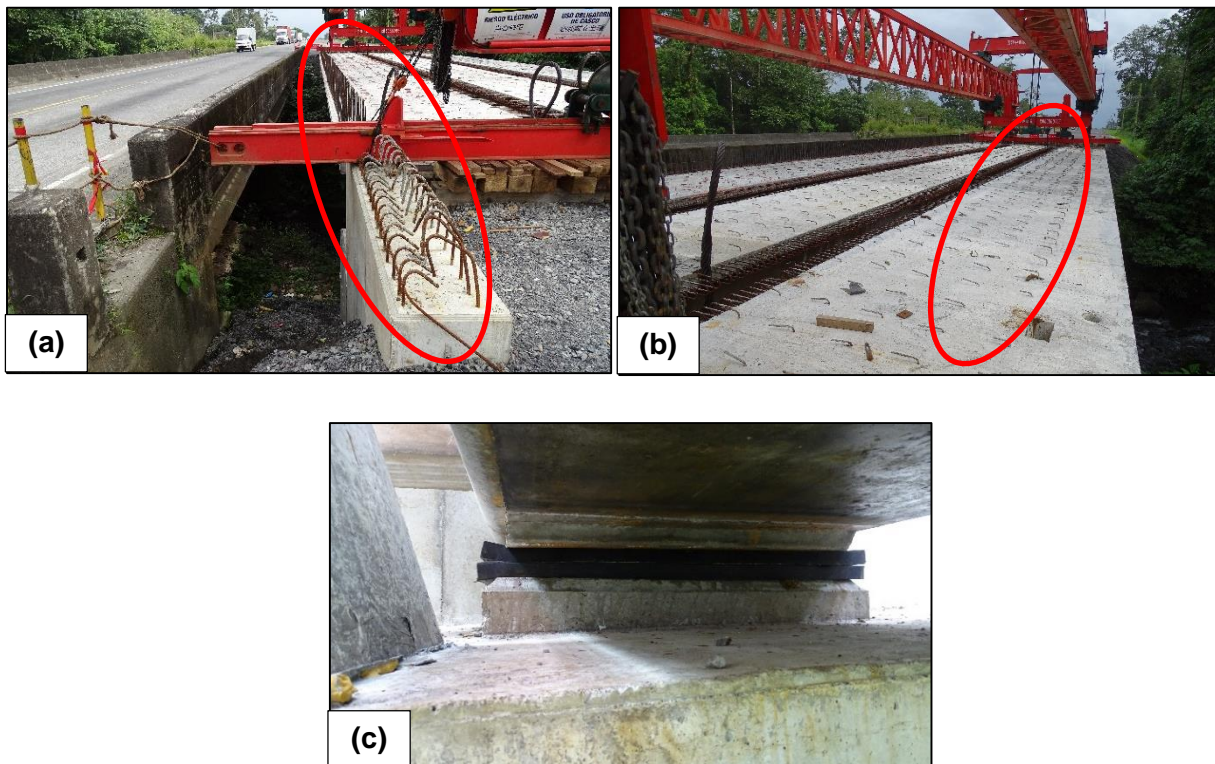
Avance en la construcción del puente sobre el Río Molinos. (a) Parte inferior de las vigas de la superestructura, al fondo el Bastión 2 (lado de Limón). (b) Parte superior de las vigas de la superestructura. La grúa y el equipo para izado aún estaban presentes en el sitio.
